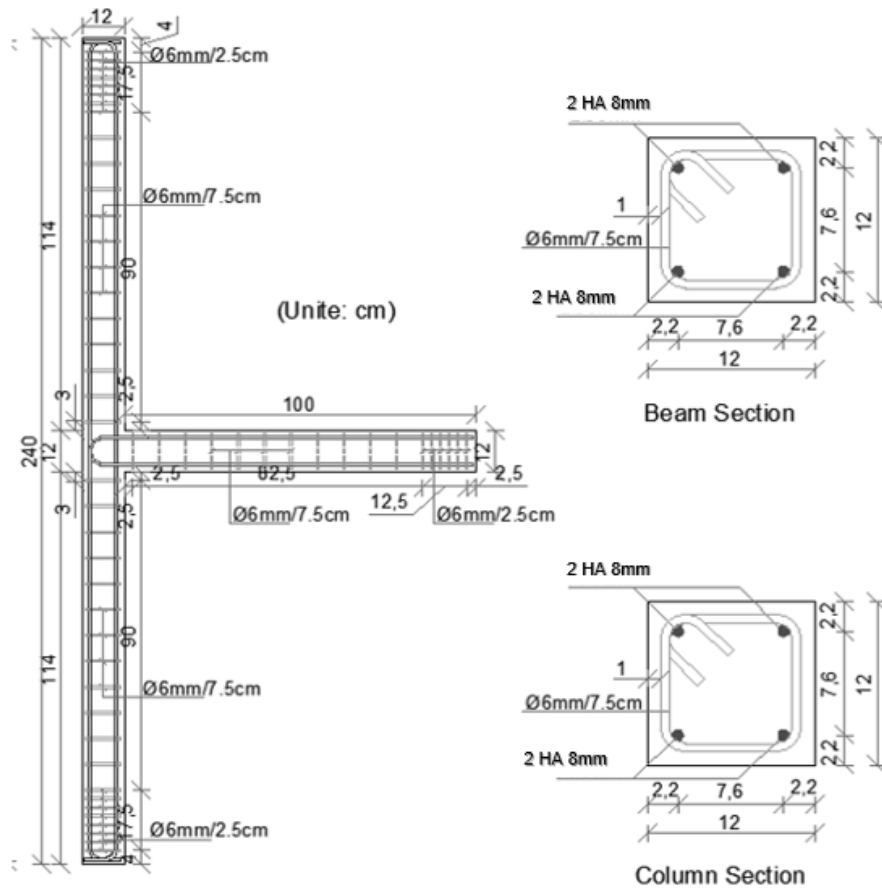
Géométrie et ferrailage de l'assemblage extérieur poutre-poteau
